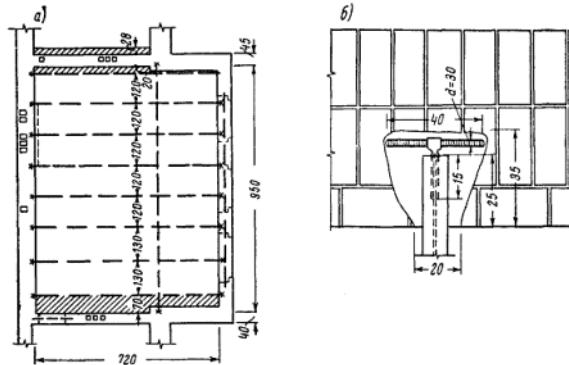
Перекрытие из стальных балок с заполнением плоскими железобетонными плитами
